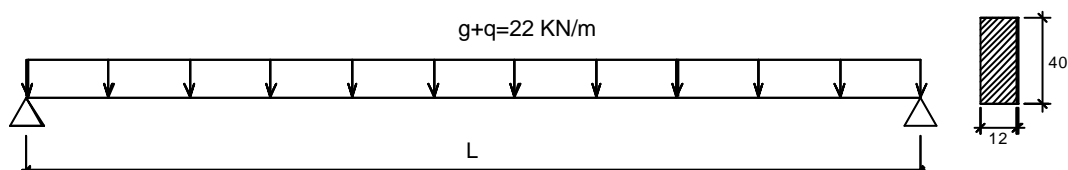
Esquema estrutural da viga do exemplo 5
